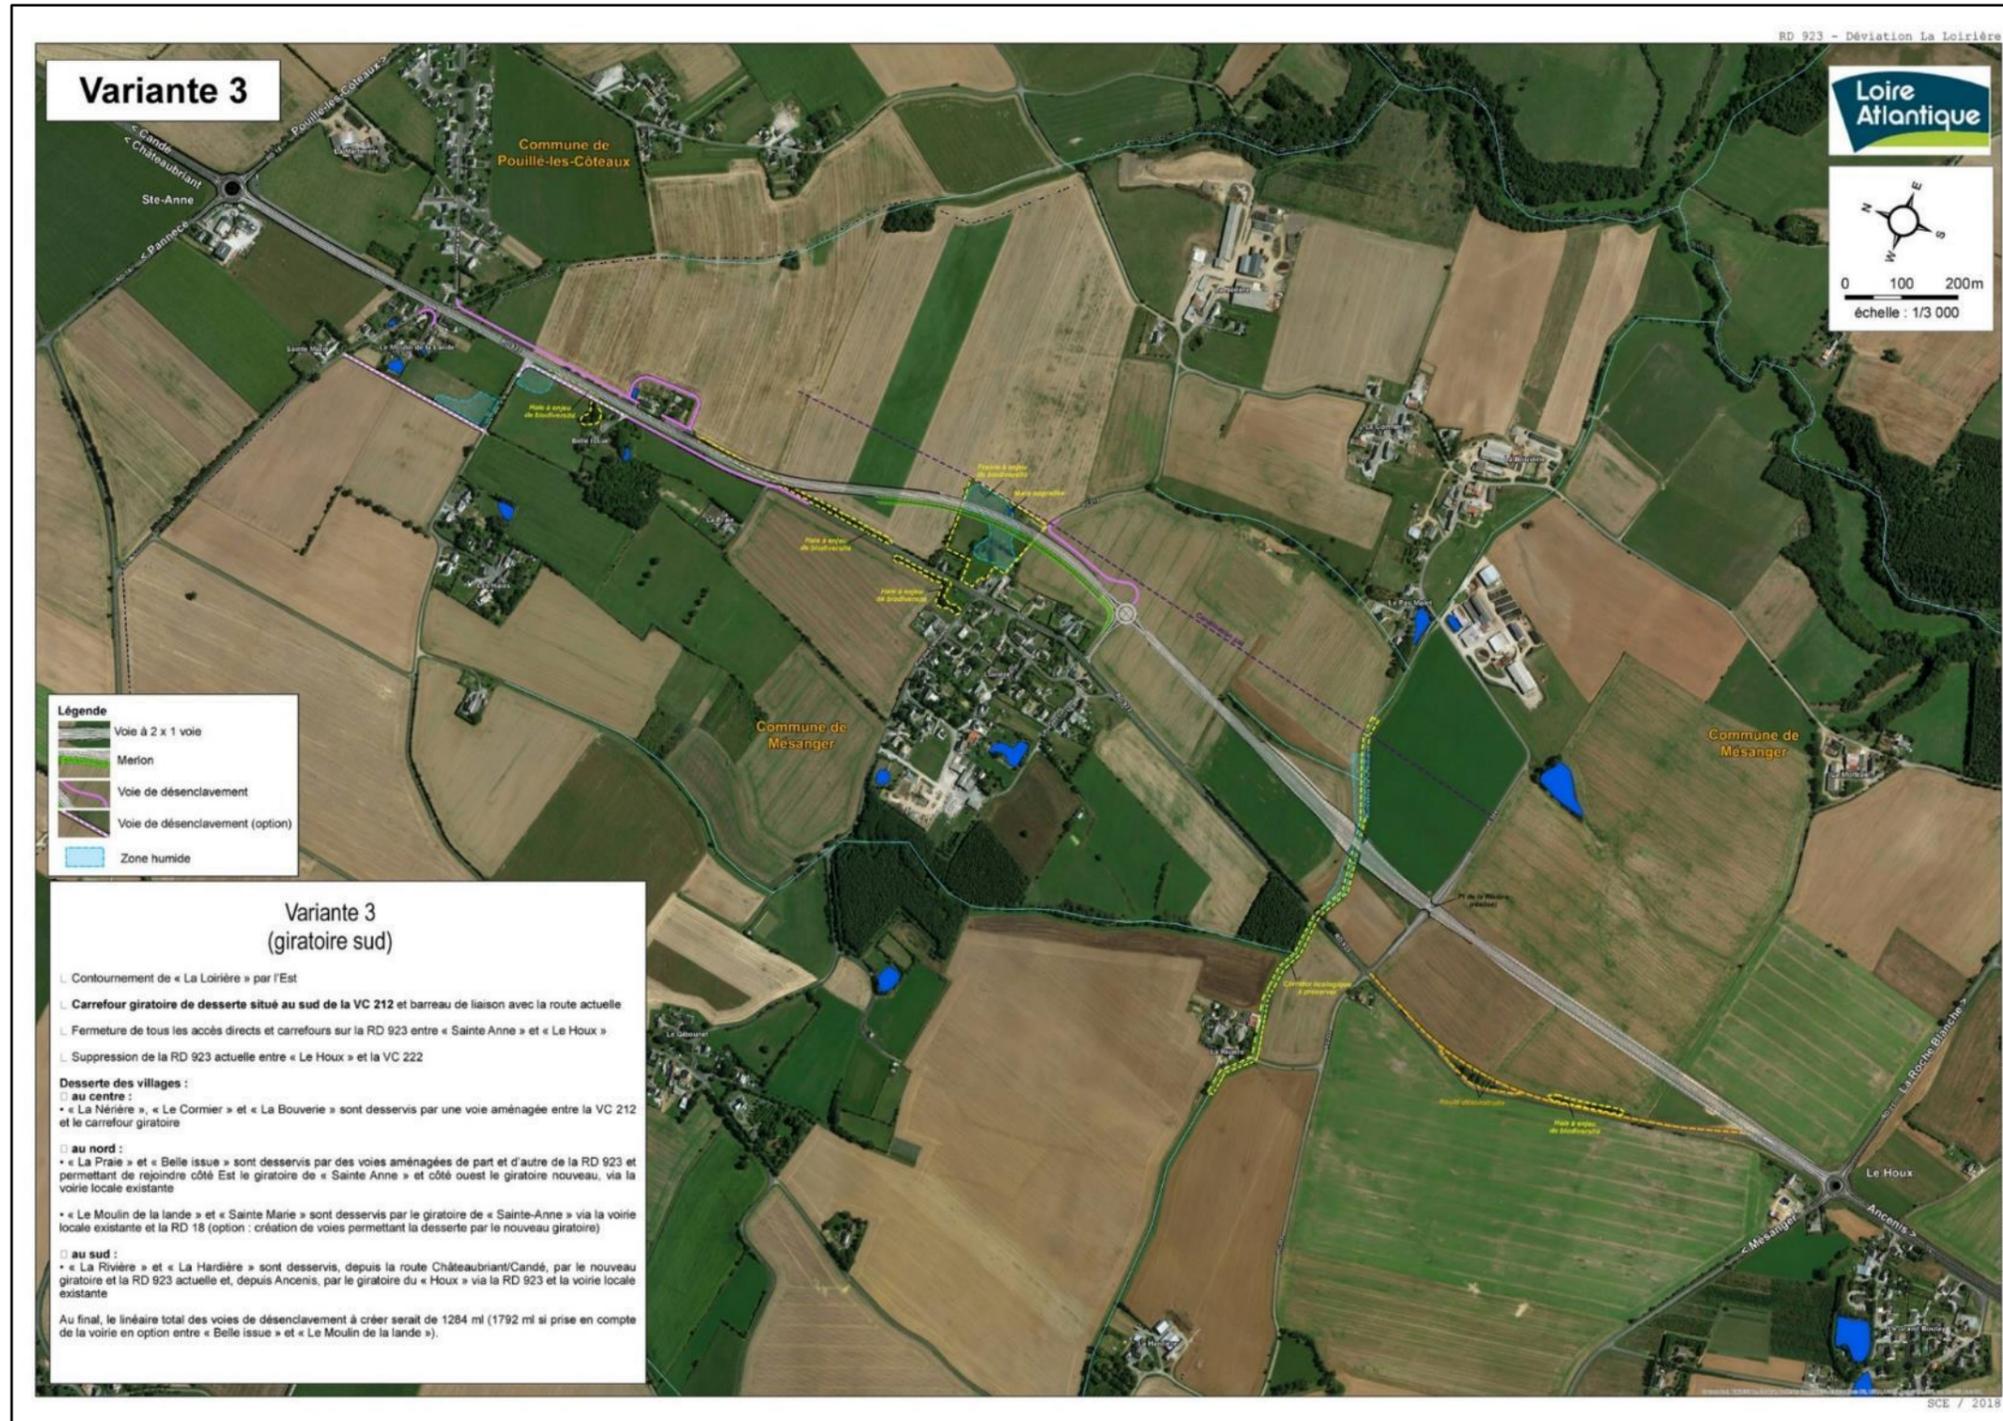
Plan de la variante 3 (carrefour giratoire Sud)
